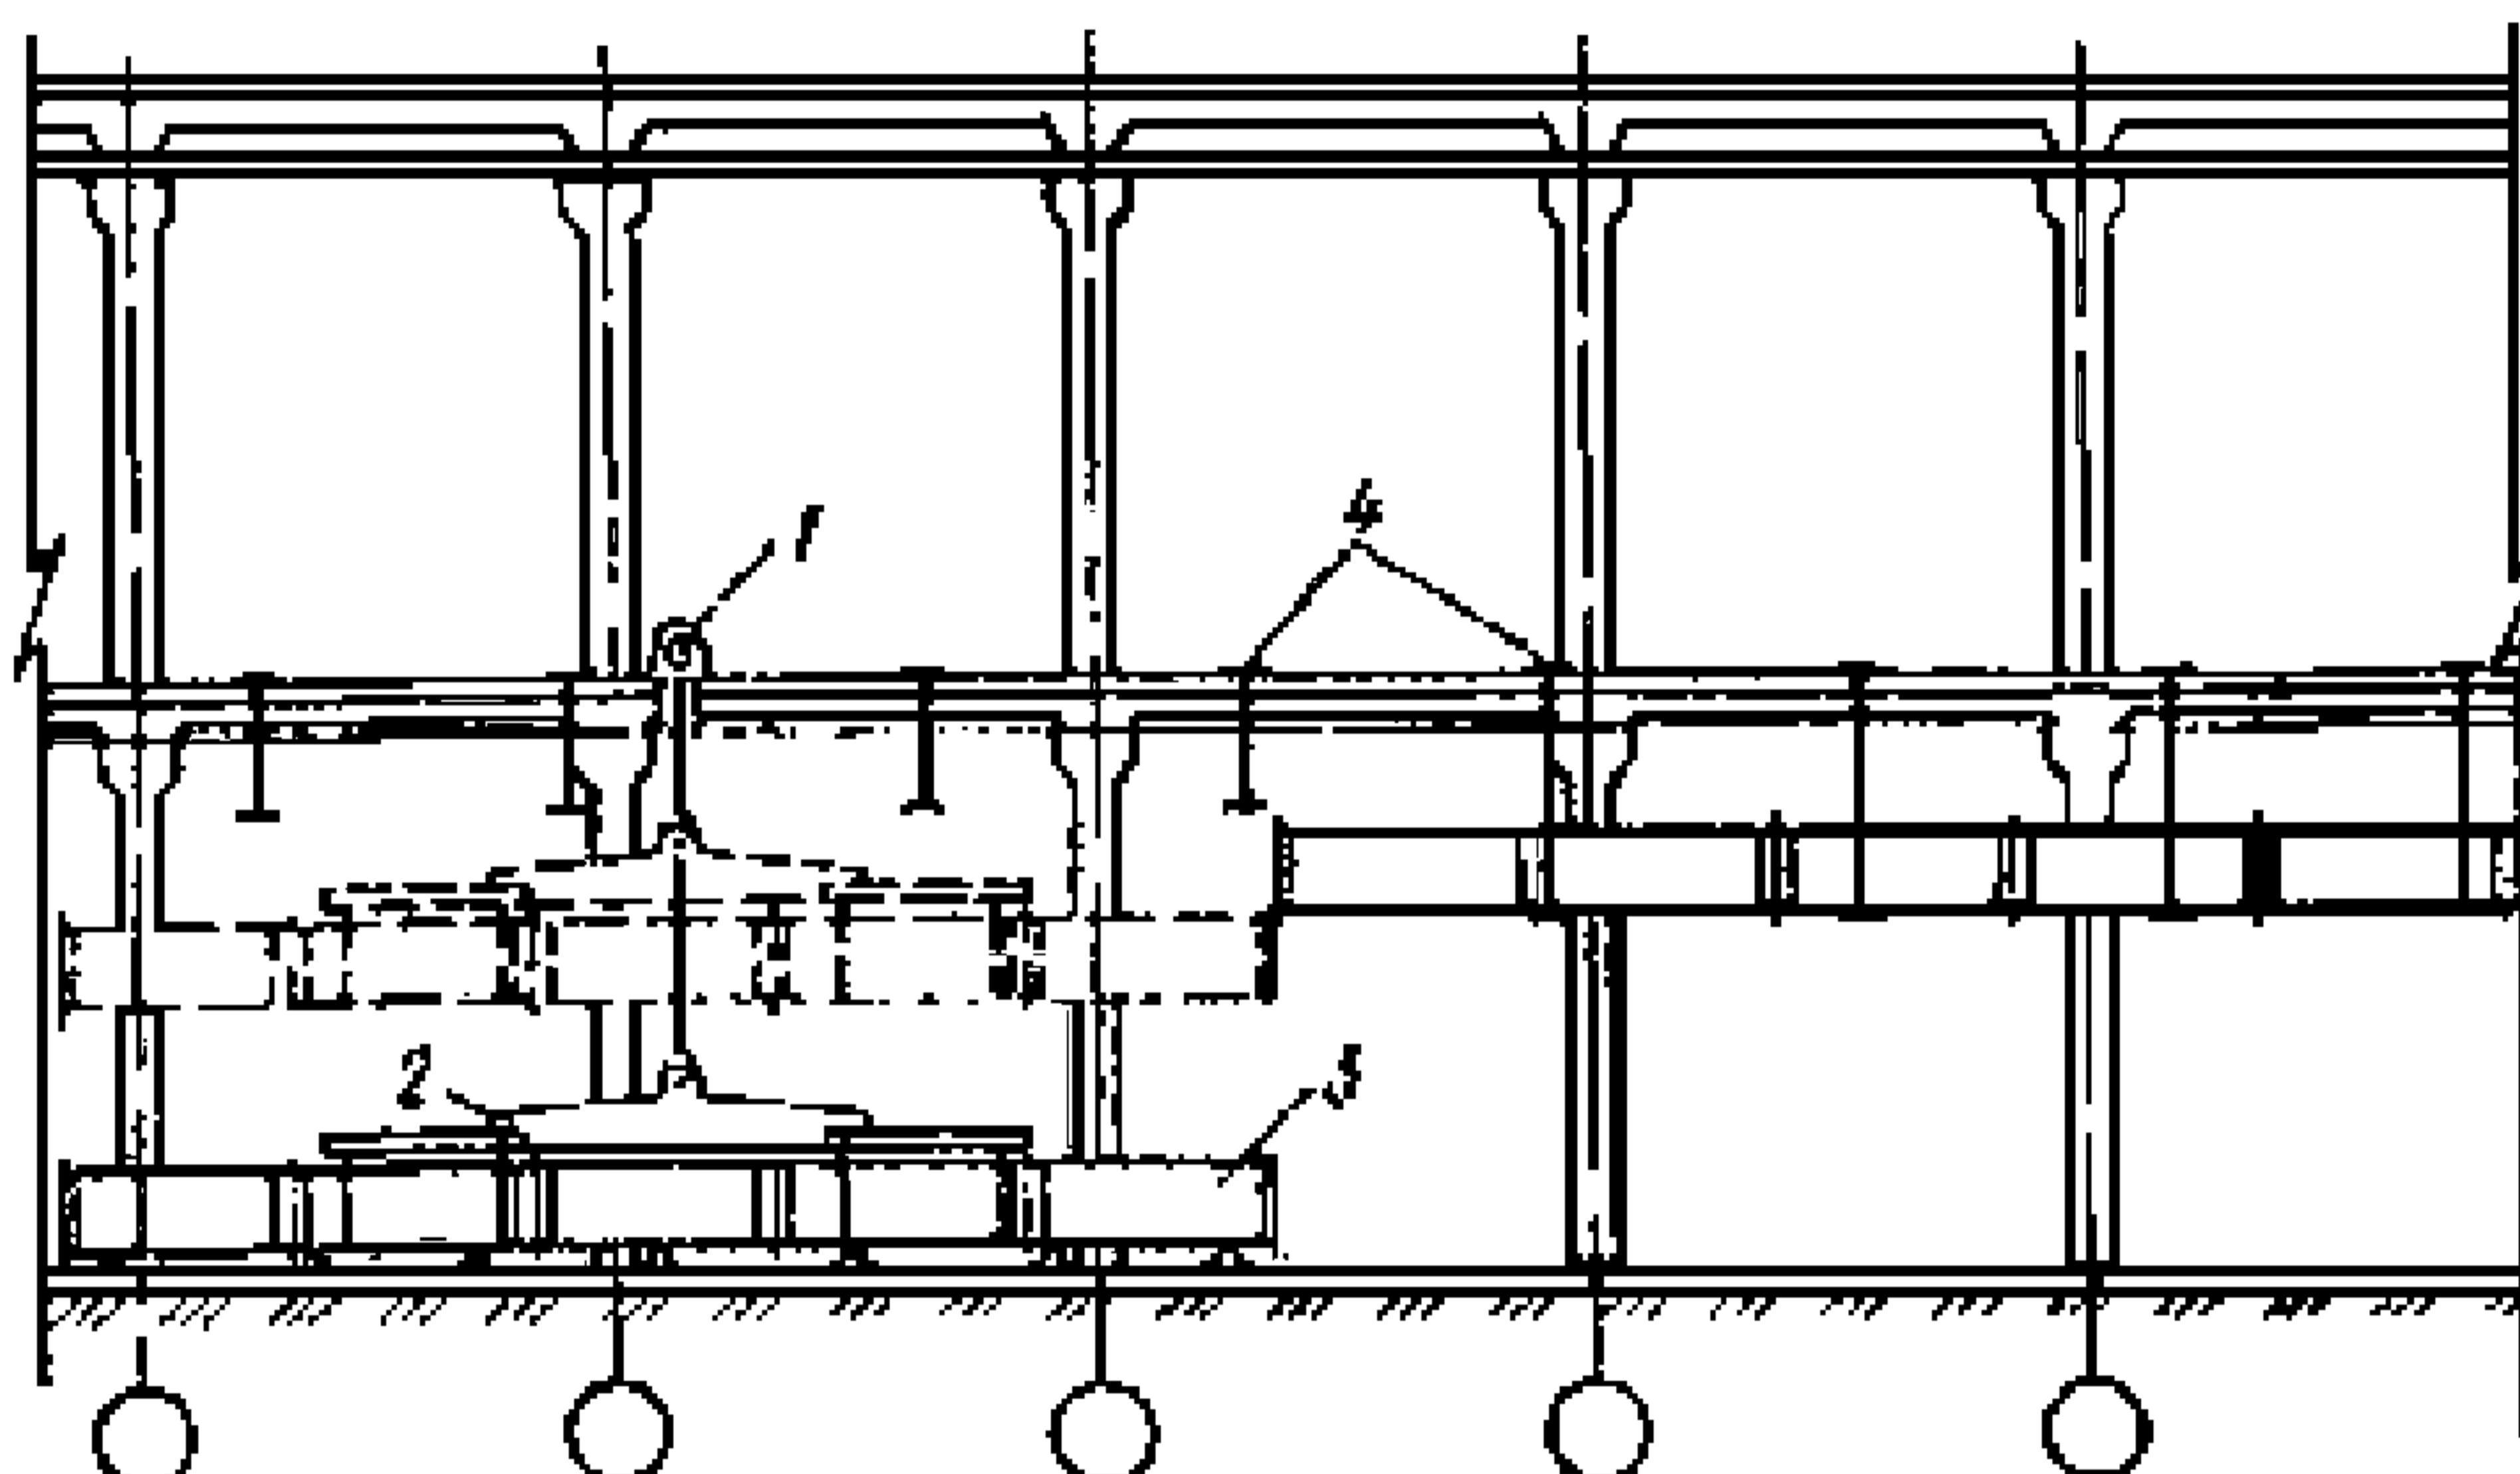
Схема организации рабочей зоны при монтаже горизонтальных воздуховодов в здании
